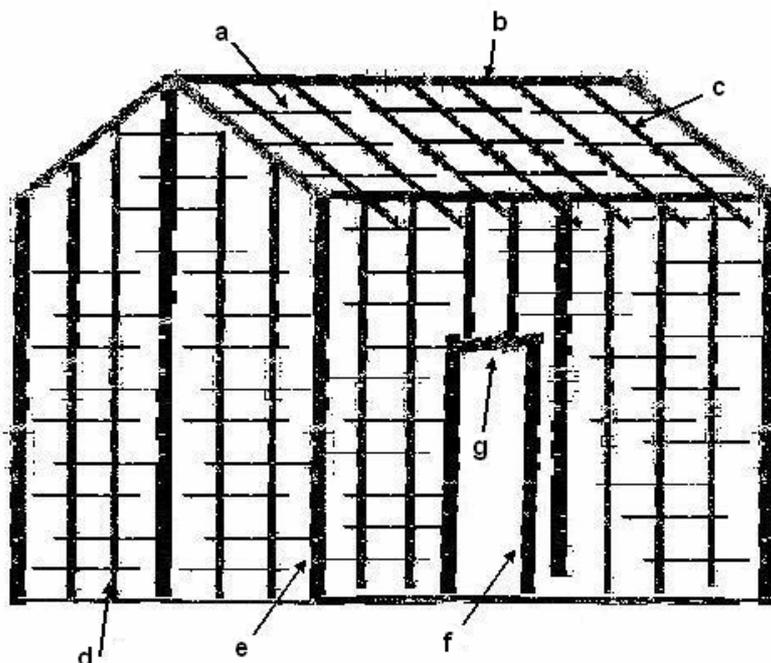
Esquema de uma casa indicando a utilização de madeiras: a=ripa, b=linha, c=caibro, d=enxaimel, e=esteio, f=estronca, g=tábua.
